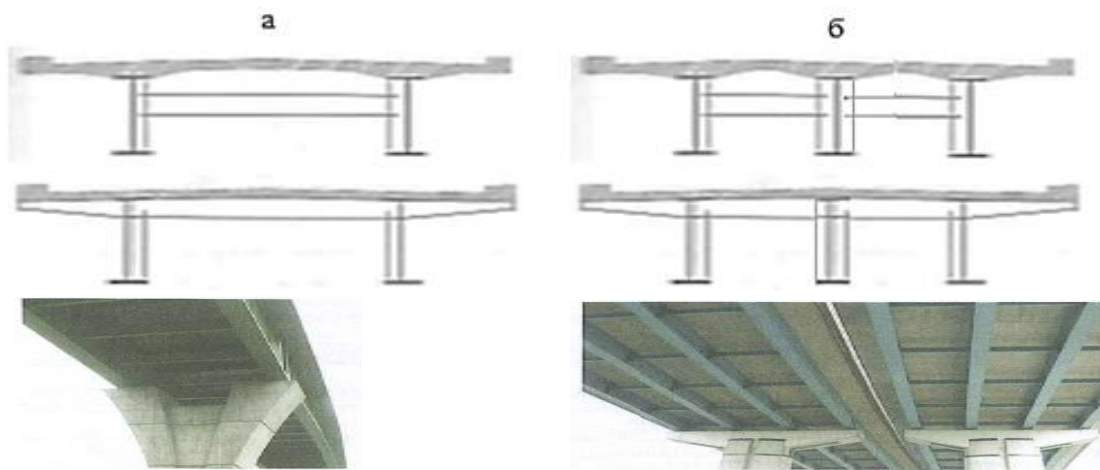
Типові перерізи прогонових будов сталезалізобетонних мостів з двотавровими балками
